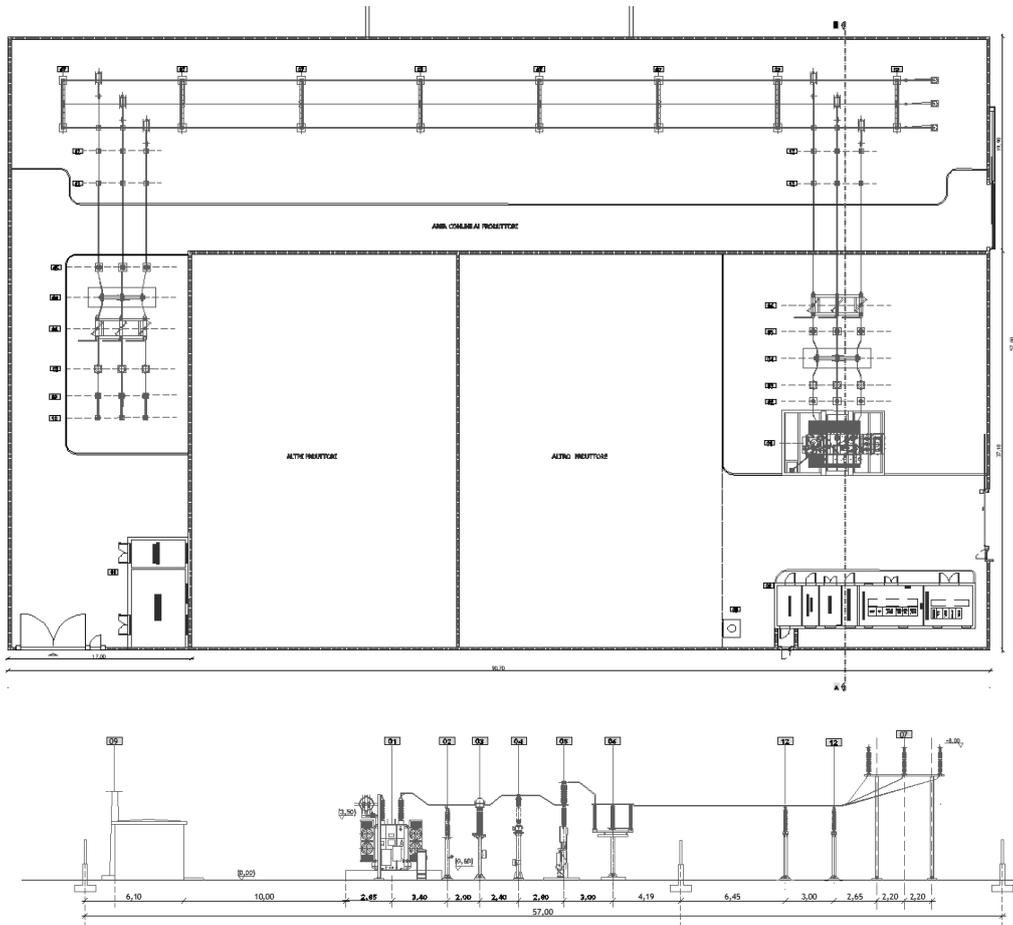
Planimetria elettromeccanica della Stazione Elettrica di Utanza
